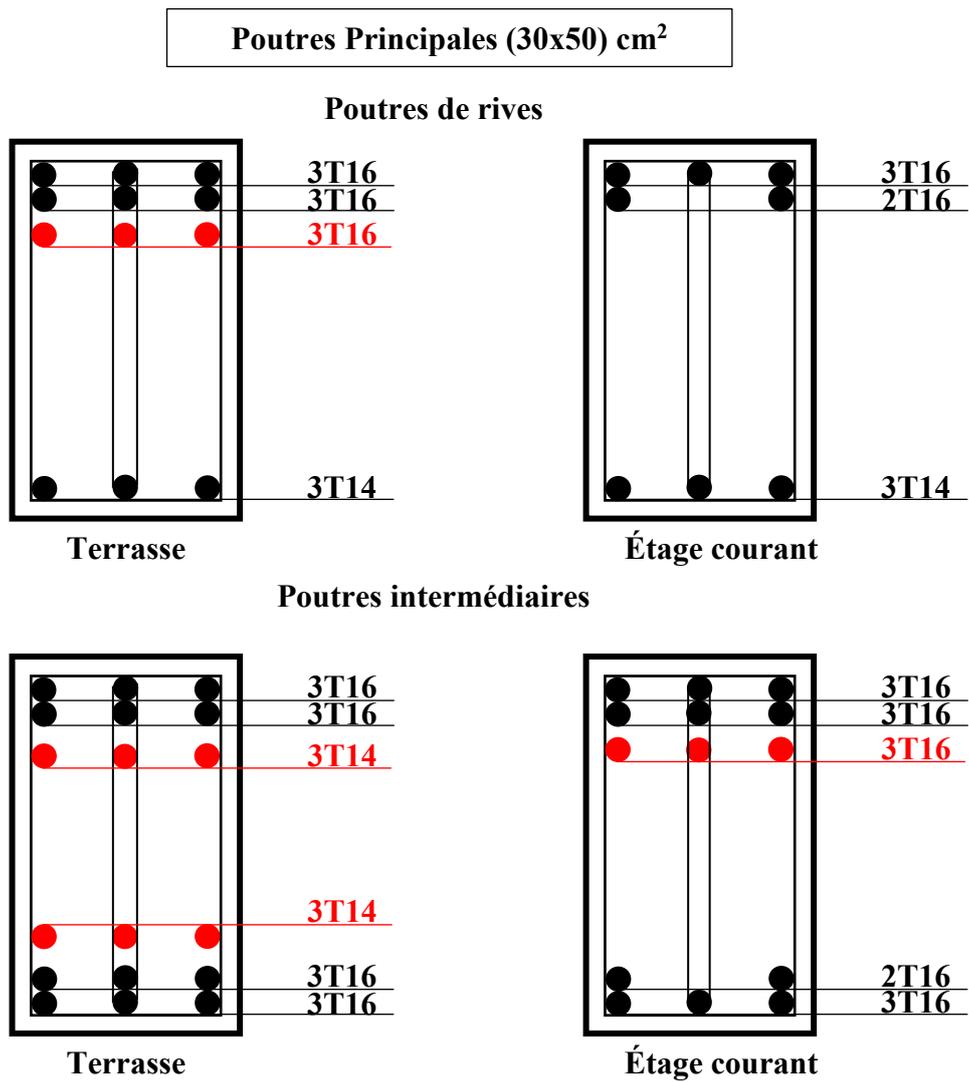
Dessin de ferrailage des sections des poutres principales
